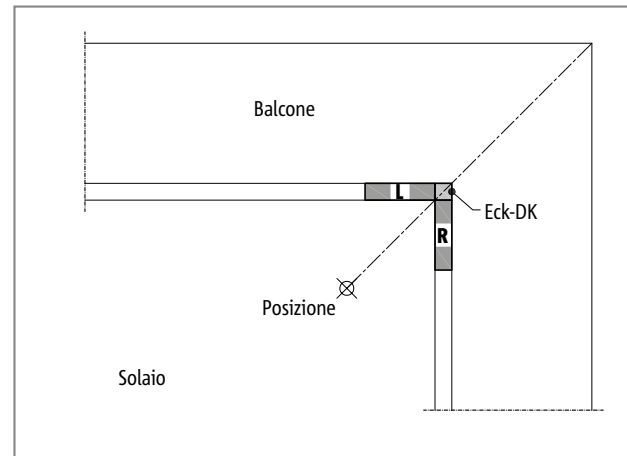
Schöck Isokorb® tipo EXT: disposizione EXT-L a sinistra della posizione; disposizione EXT-R a destra della posizione
